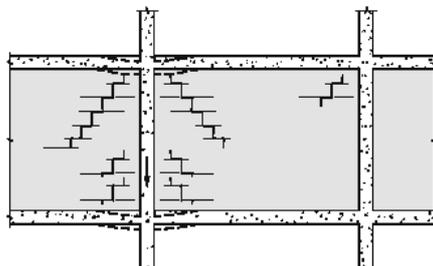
Assentamentos diferenciais entre pilares: surgem fissuras inclinadas na direcção do pilar que sofreu maior assentamento
